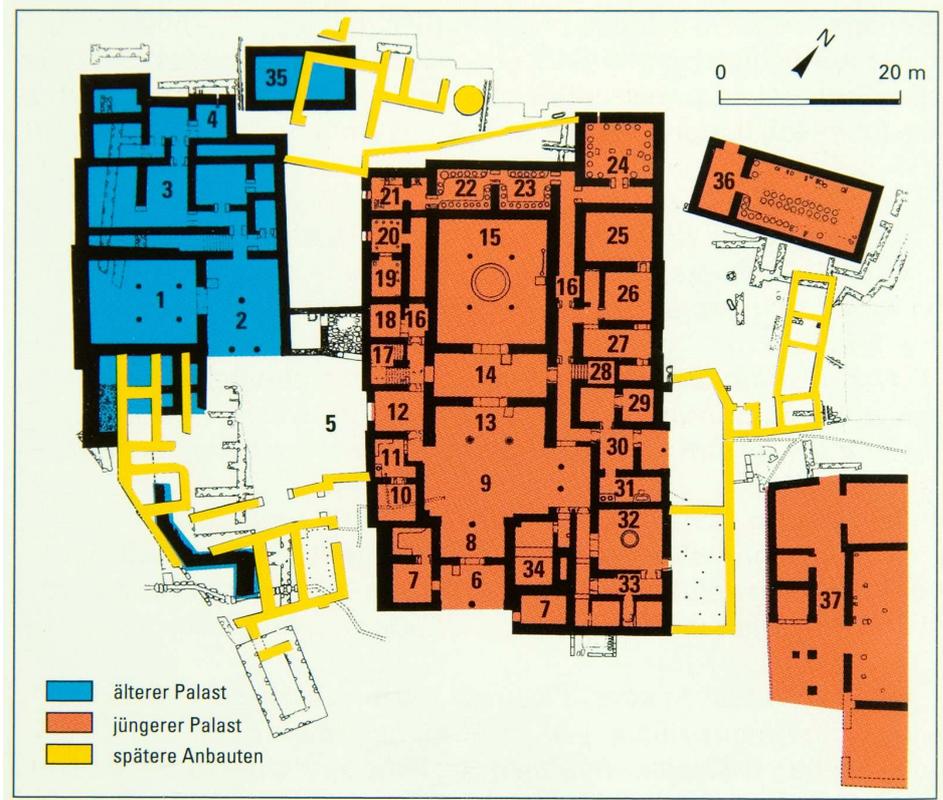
Pylos, Grundrissplan nach L. Schneider.
